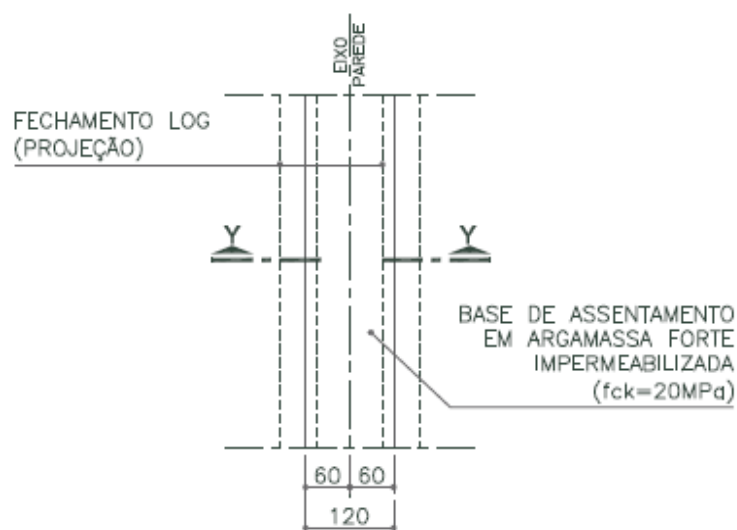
Planta baixa do detalhe de assentamento da parede em *log*. Projeto cedido pela EMPRESA B.
